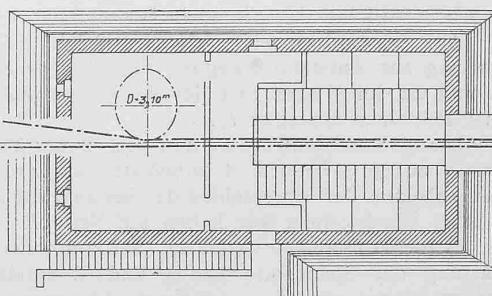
Obere Station der neuen Seilbahn. — Grundriss 1:300.
